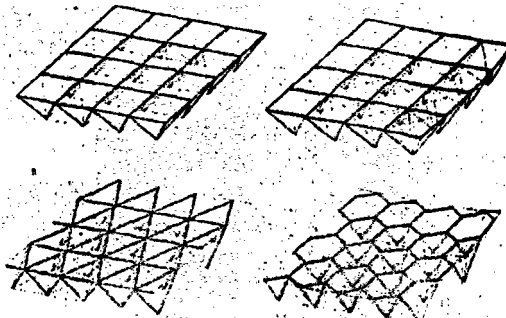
Схемы перекрестно-стержневых конструкций из решетчатых пирамид: а, б – из пирамид с квадратным основанием (пентаэдров); в – из пирамид с треугольным основанием (тетраэдров); г – из пирамид с шестиугольным основанием (гептаэдров)
